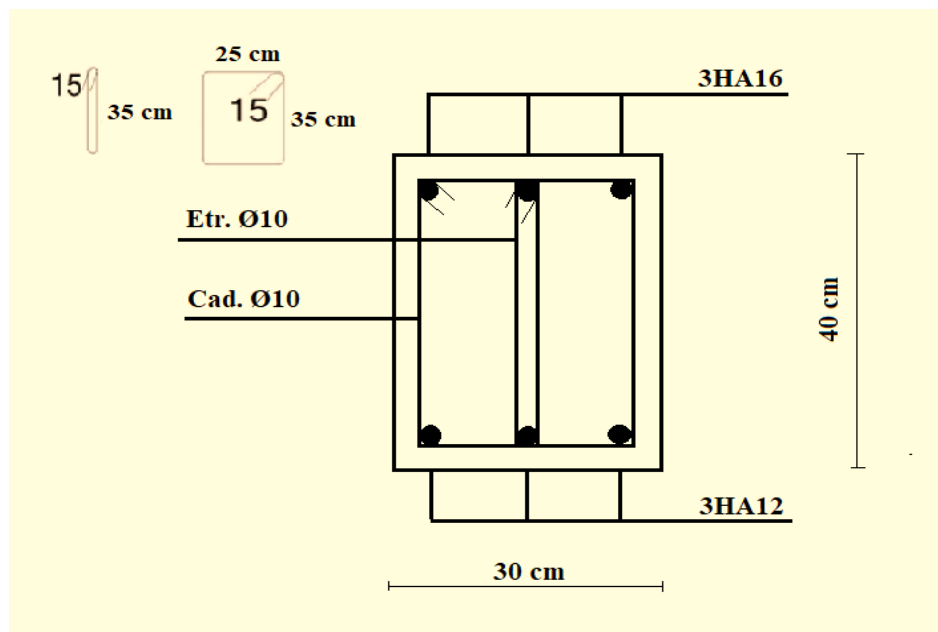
Ferrailage des poutres secondaire au niveau d'appuis pour 2^{ème} ; 1^{ère} étage et RDC.
